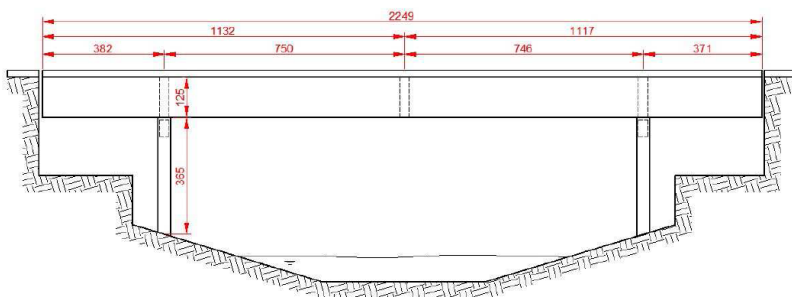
Seção transversal da superestrutura da ponte (dimensões em cm)
